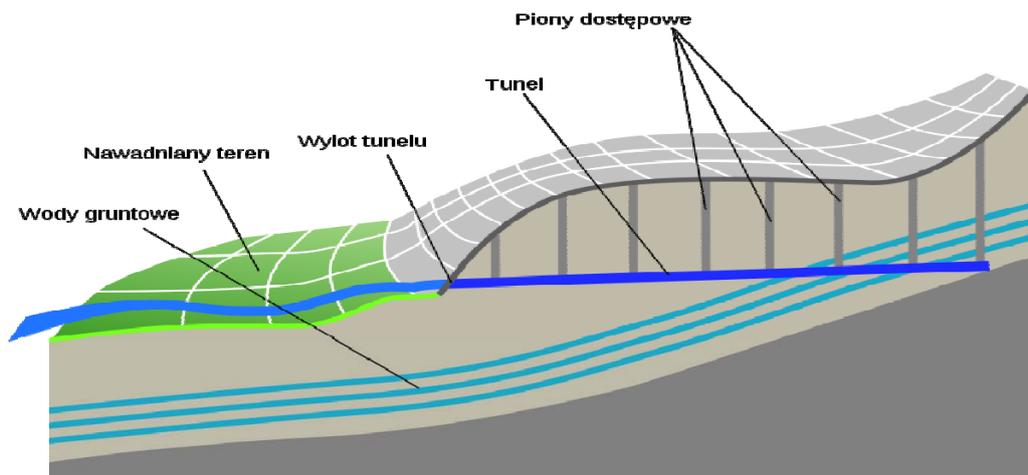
Schematische Darstellung eines Qanat-Systems in Grundriss
